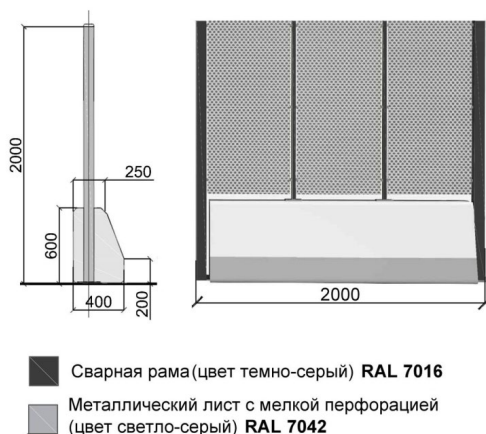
Временное ограждение строительной площадки (тип 3Б Н)
